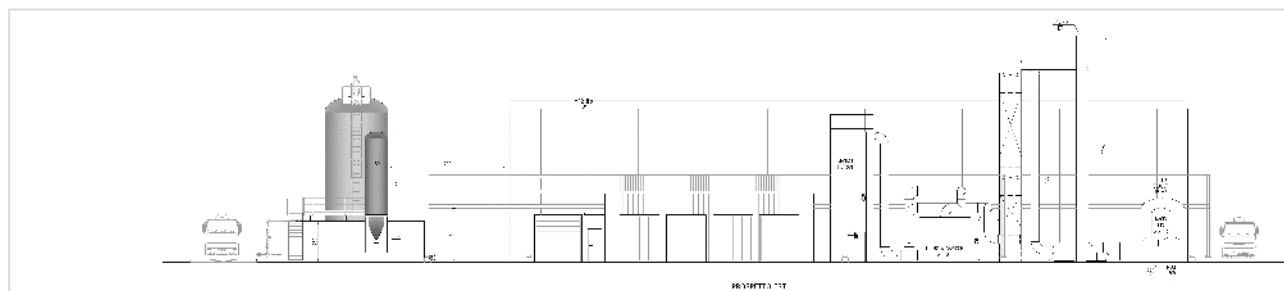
Vista in sezione degli edifici N8 e N10 della piattaforma polifunzionale HEA (stralcio elaborato CO 05 RA VA 00 D1 PL 65.00 - N8-N10 PROSPETTI E SEZIONI)
